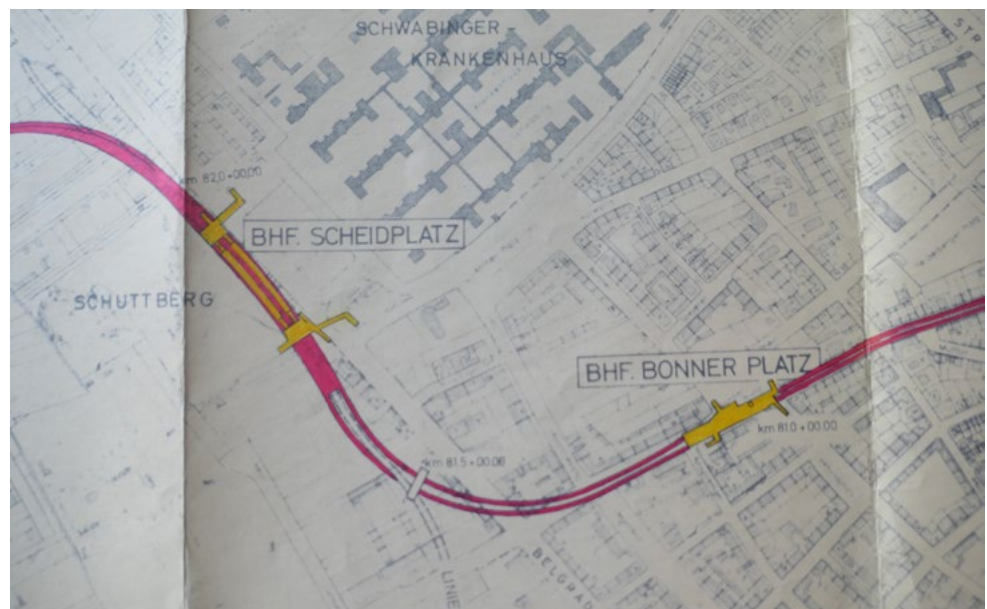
Ausschnitt aus dem Streckenübersichtsplan der Olympialinie mit Darstellung der Bahnhöfe Scheidplatz und Bonner Platz, München, Lageplan 1967
